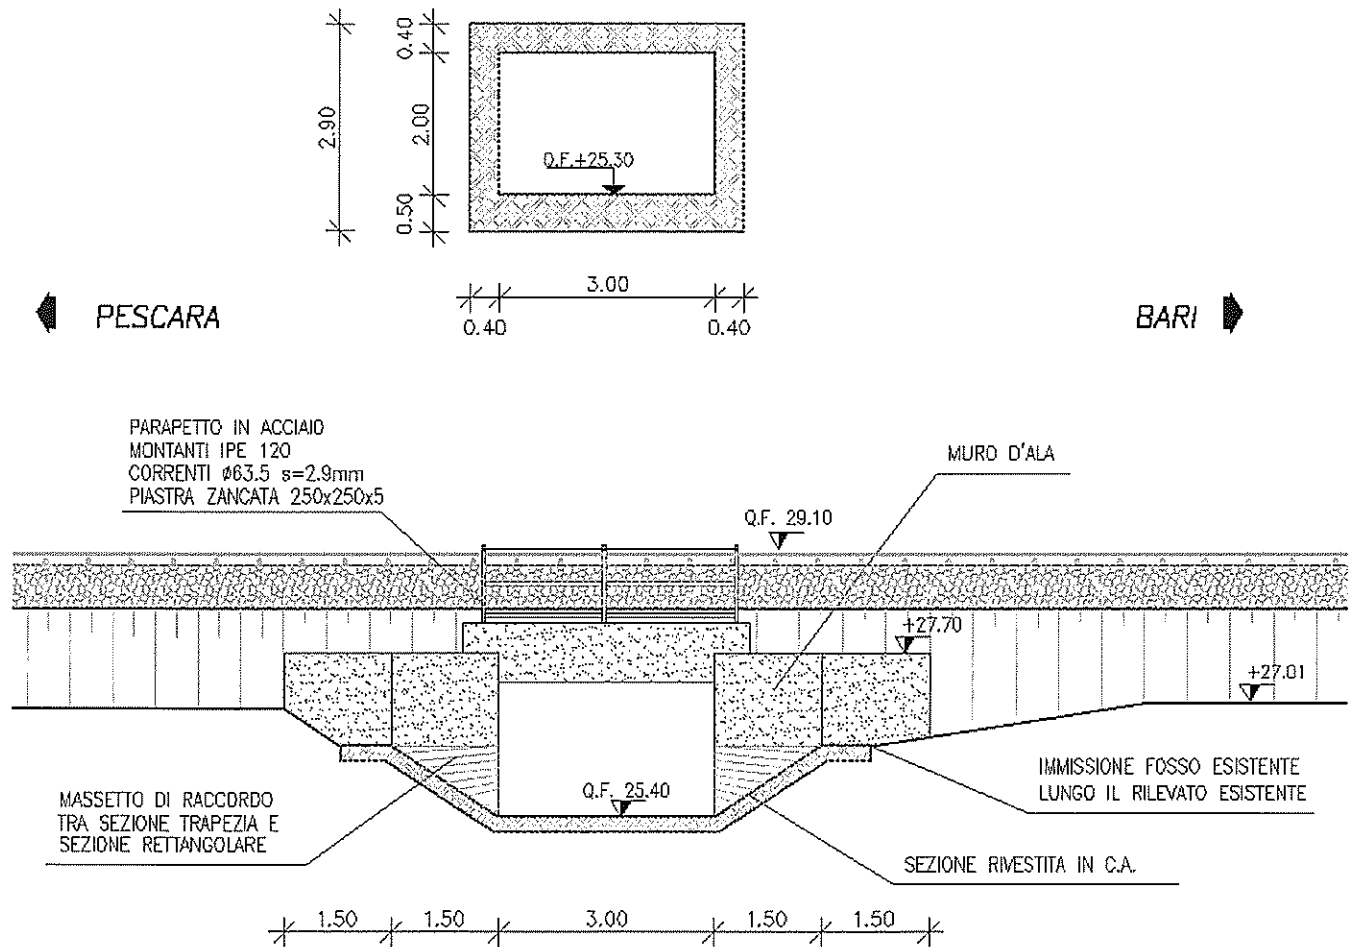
Sezione e prospetto lato monte del nuovo tombino Canale Pontonicchio
